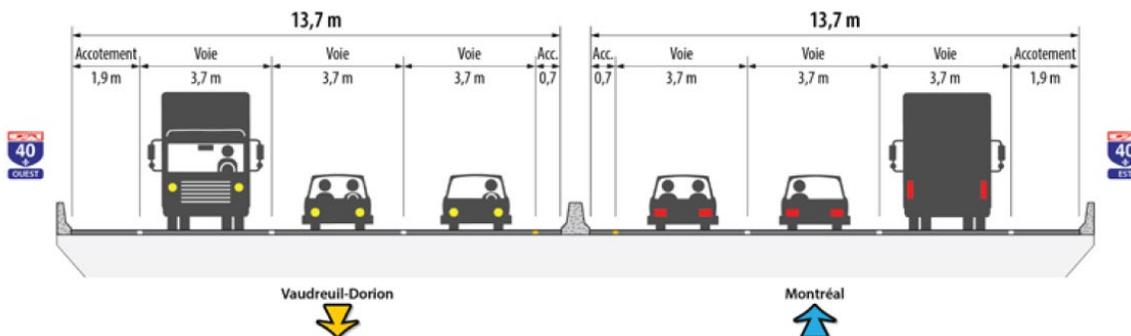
Coupe transversale – Espaces de circulation sur le tablier du pont actuel
